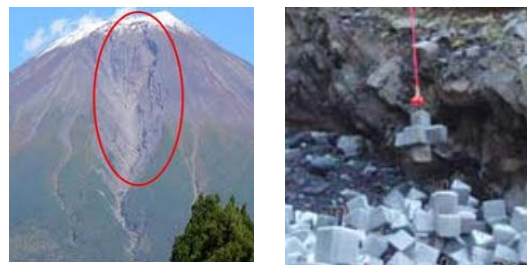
富士山の崩壊地「大沢崩れ」 写真-2 投下型コンクリート部材の例 (富士砂防 HP)
